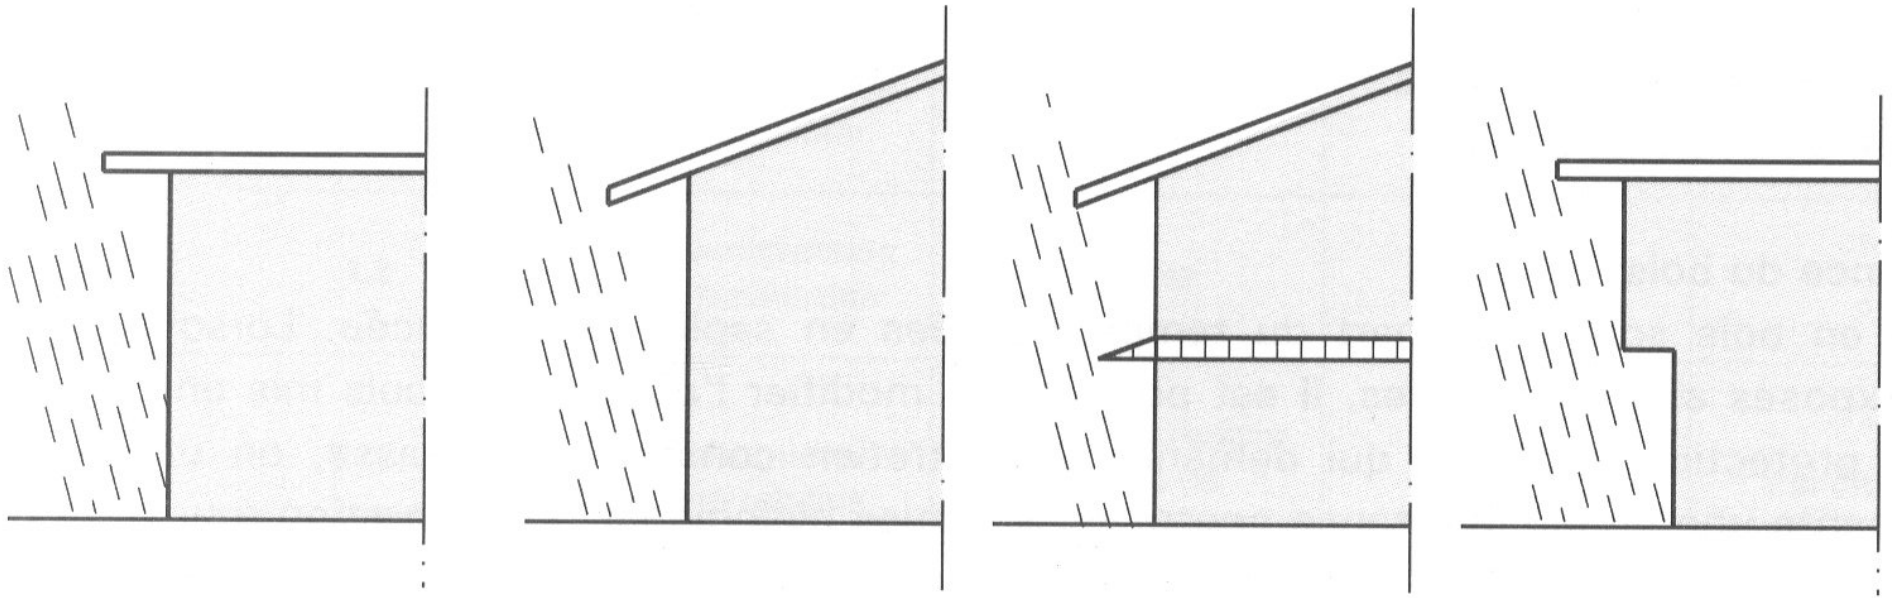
Influence de la géométrie de l'ouvrage sur la protection des façades.
